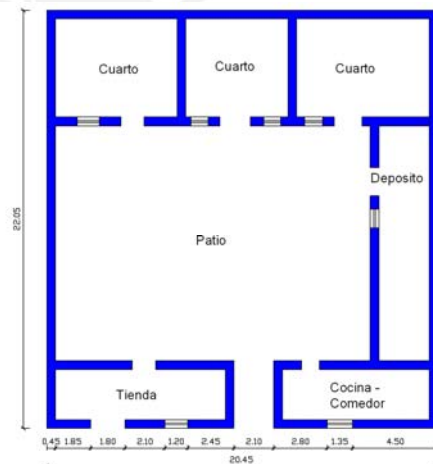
Vivienda de tapial con planta en forma de C con patio interior
